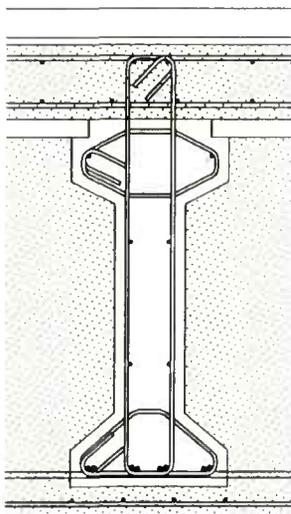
Principe du ferrailage du tablier dans la section sur pile.
